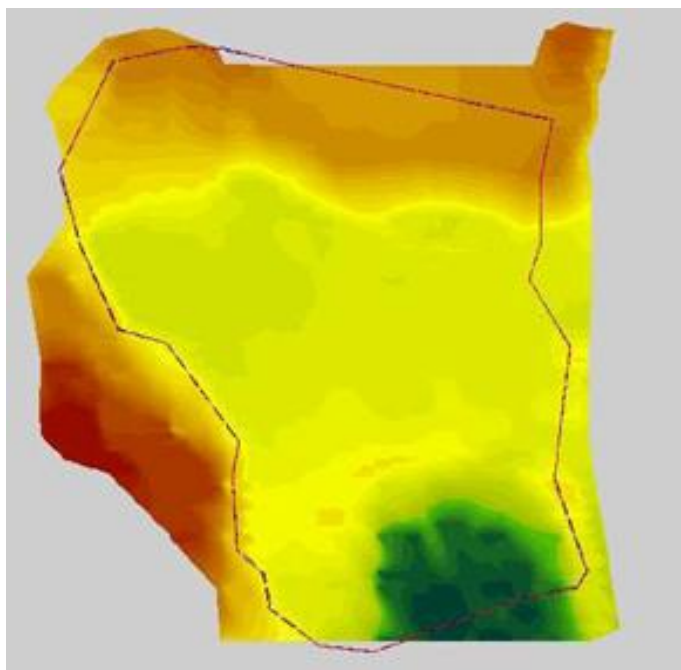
Розрахунок об'єму для початкової поверхні
